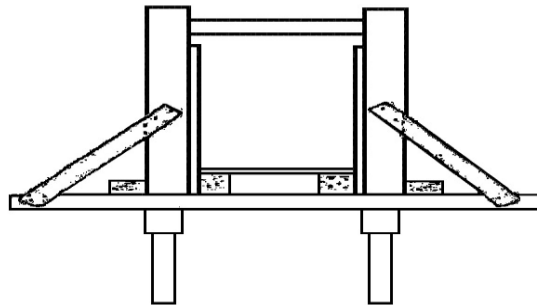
Konstruksi tepi pada pelat lantai beton balok T maupun yang datar
